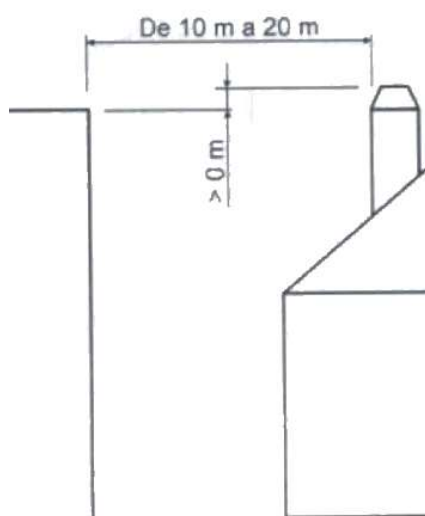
Distanza tra la finitura e oggetti tra 10 e 20 m
